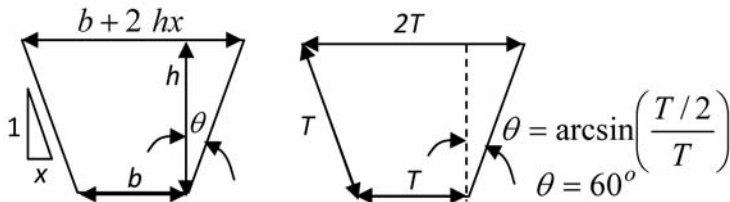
Secção trapezoidal hidraulicamente mais eficiente.
